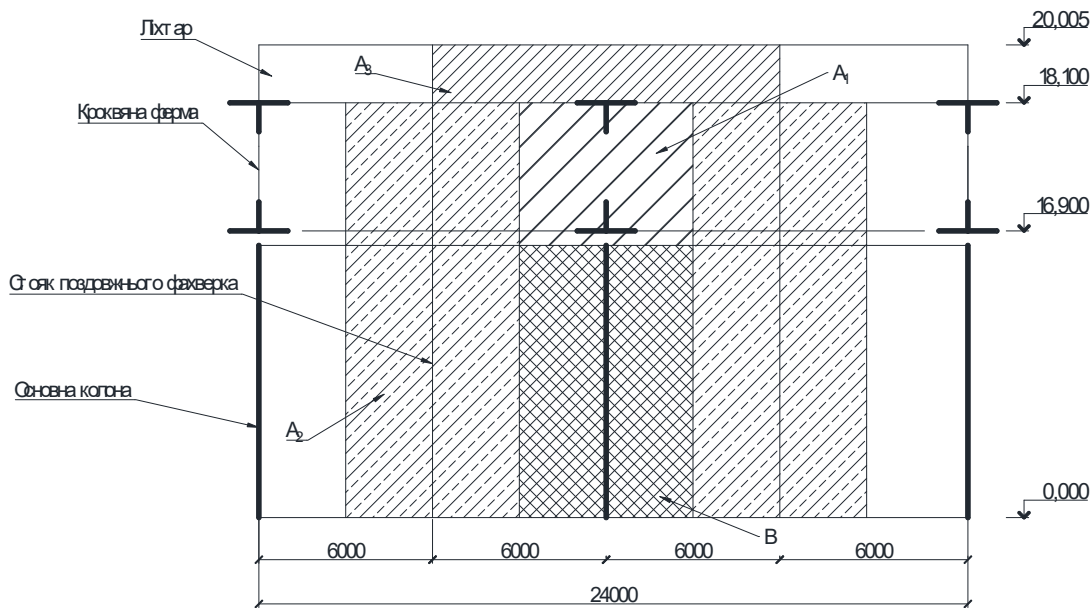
Схема розподілу вітрового навантаження по поздовжній поверхні будівлі.
